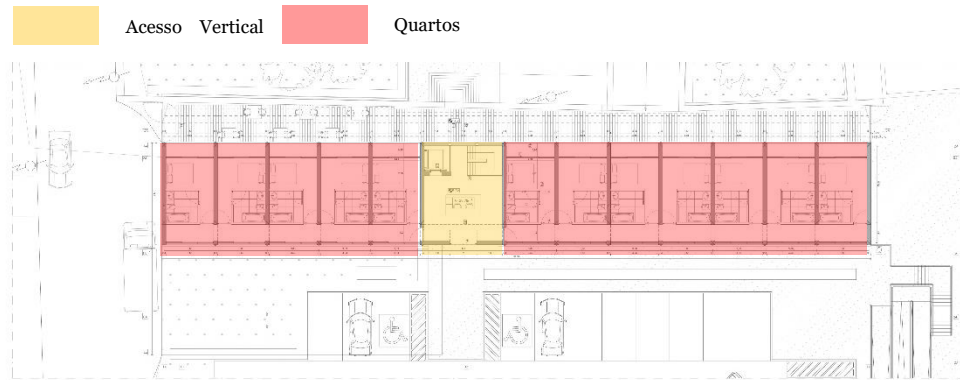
Esquema de planta do espaço de restauração e hotelaria- piso 1.
